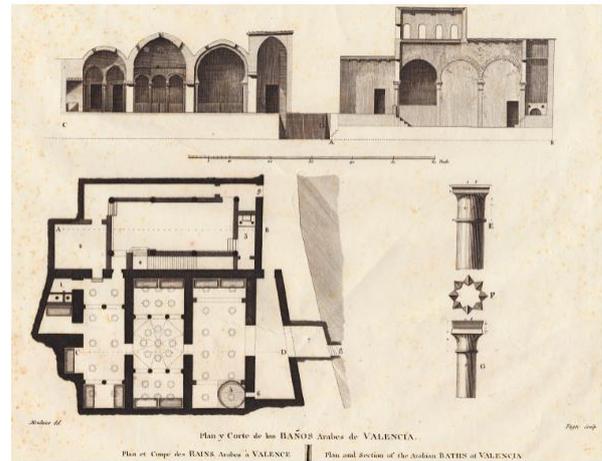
Lámina del viajero Alexandre Laborde, planta y secciones de los baños del Almirante.
